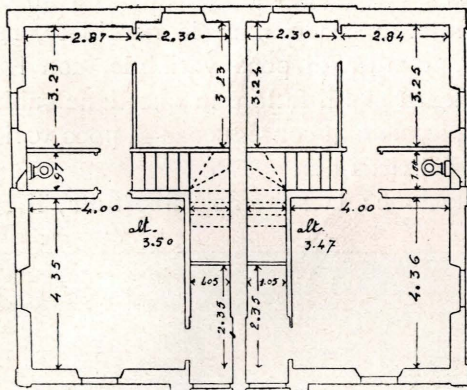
Pianta primo piano (Scala 1 : 200).
